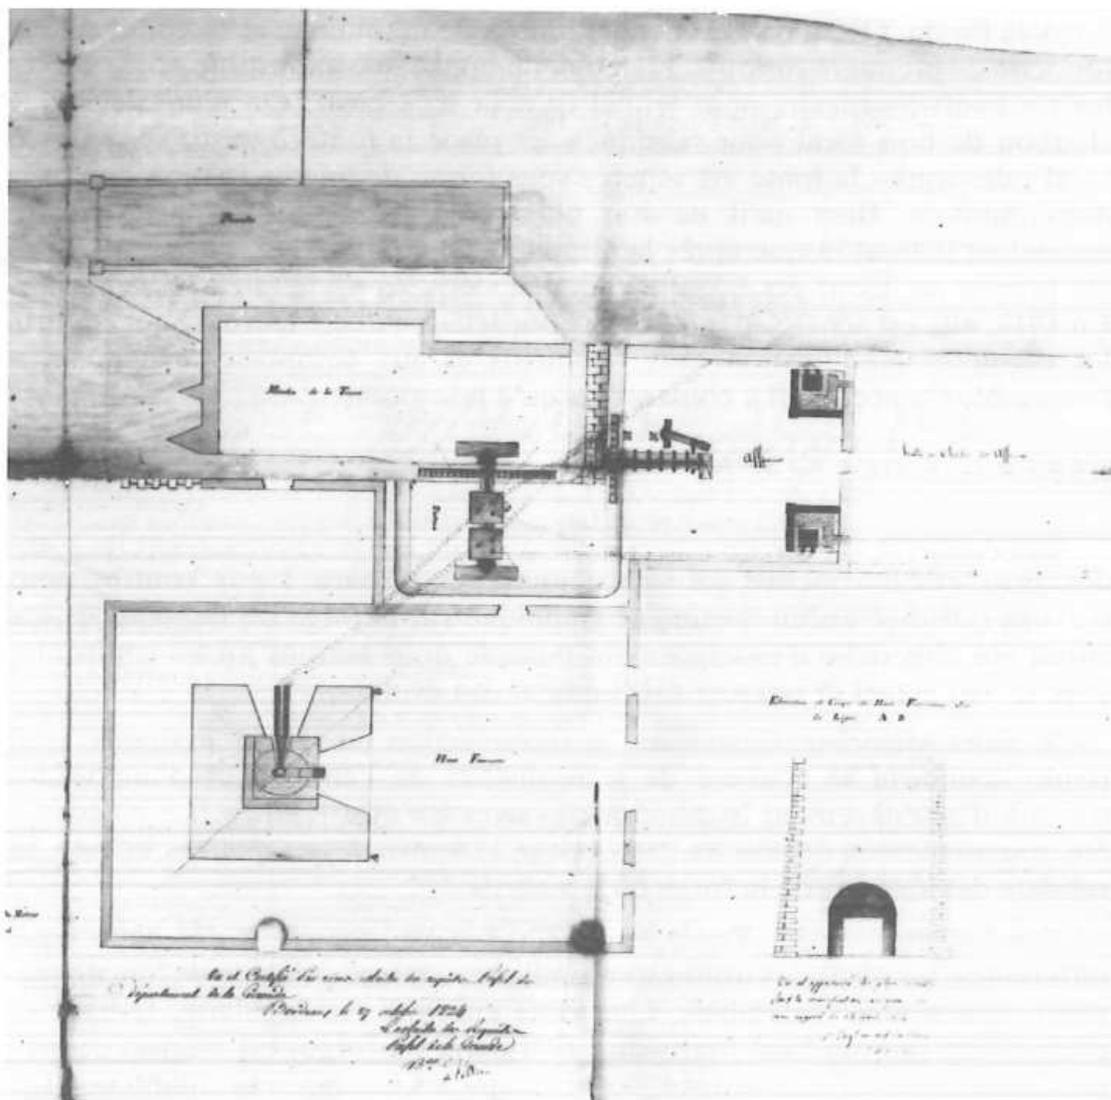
Plan de la forge de La Trave en 1825 (Archives départementales de la Gironde, S 45).
